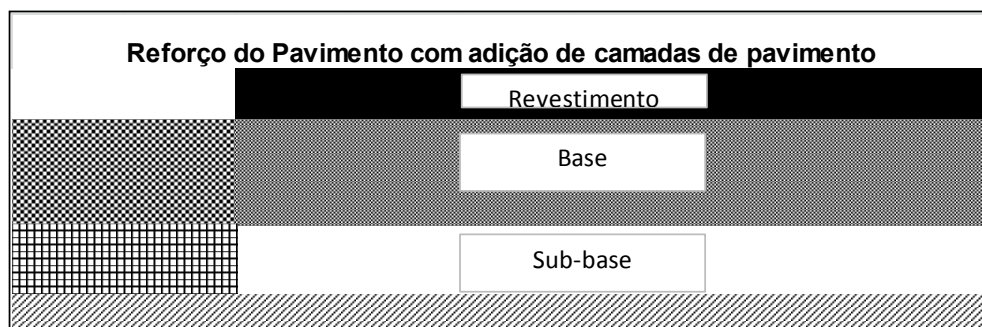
Reforço do pavimento com adição de camadas de pavimento
